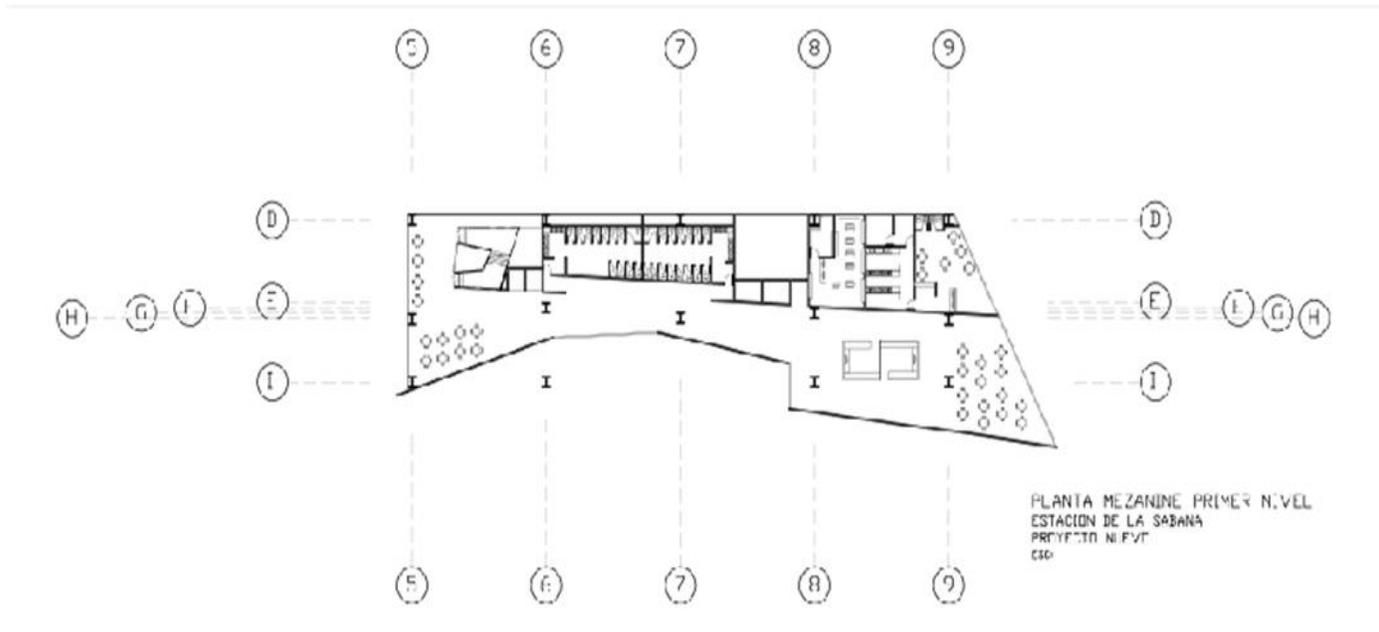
Planta Mezanine, proyecto nuevo. Estación de la Sabana.
